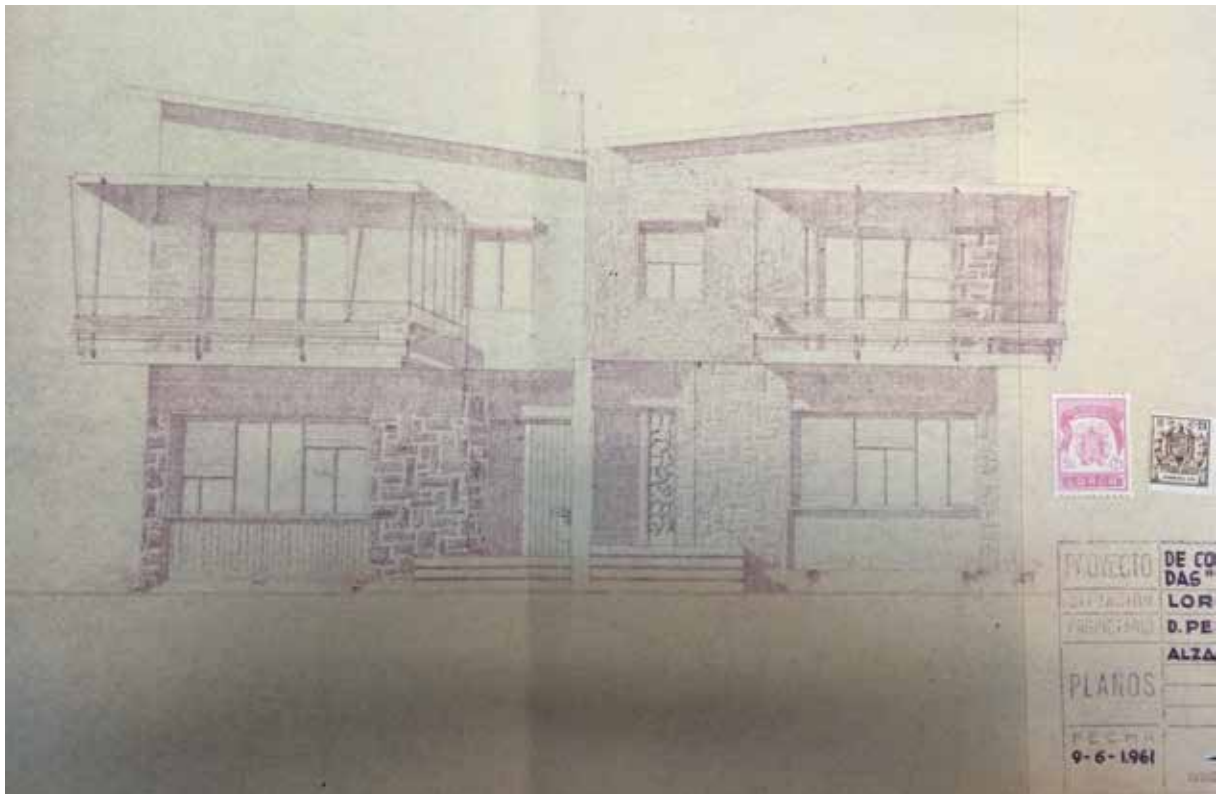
E. Sancho Ruano. Viviendas de Pedro Caro Romero. Alzado principal. (Fuente: AML)
